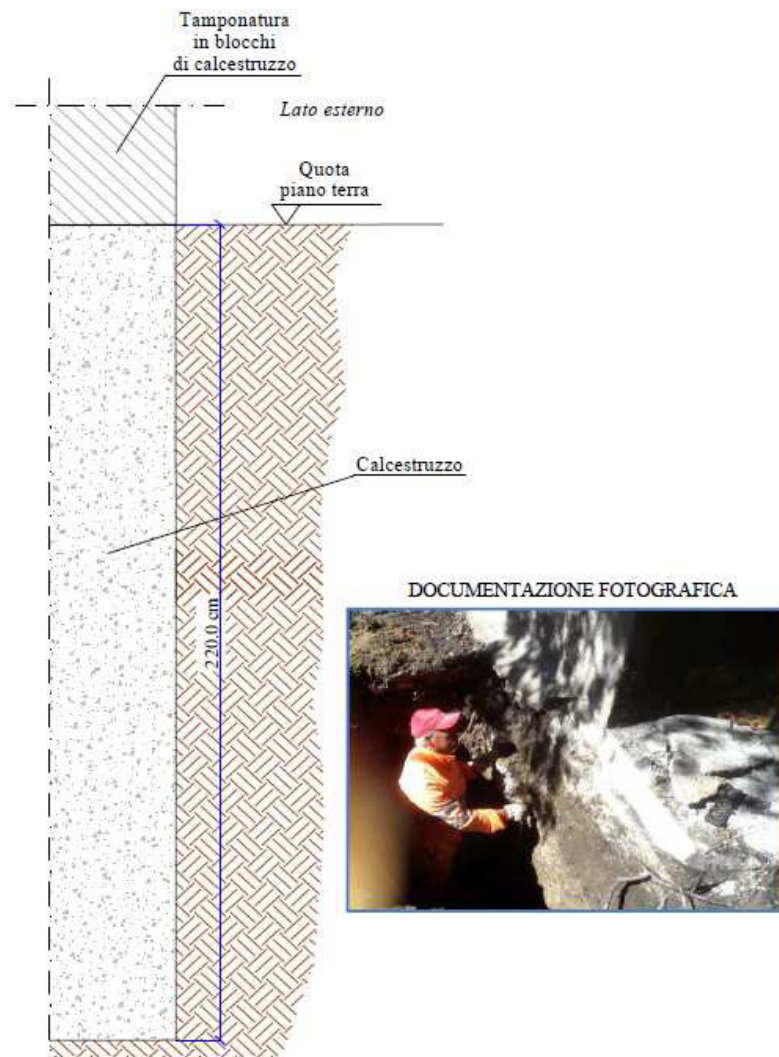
Tipologia di fondazioni individuate Corpo A (SF1- Saggio in fondazione).
